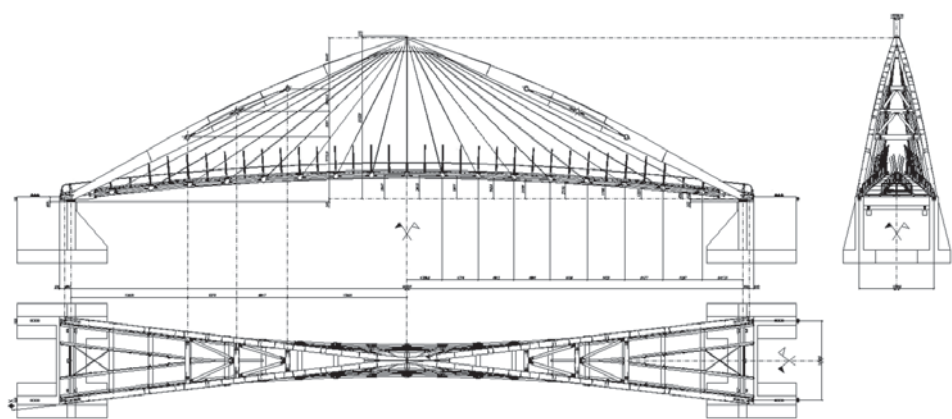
Disposizione planimetrica ed assiemi strutturali del ponte
